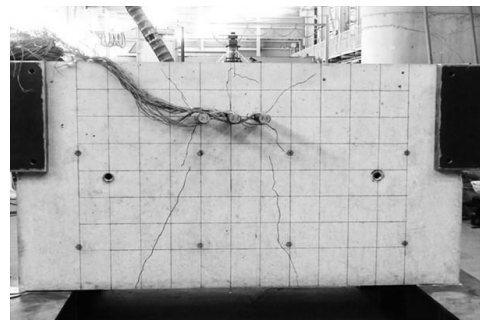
Case-3 供試体上面のコーン状のひび割れ (荷重 850kN時点)
